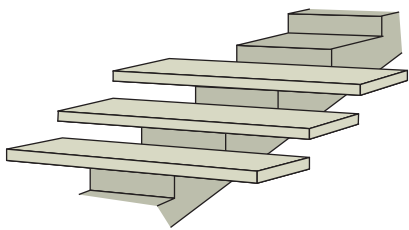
Fribärande steg på centralt placerad betongbalk.
